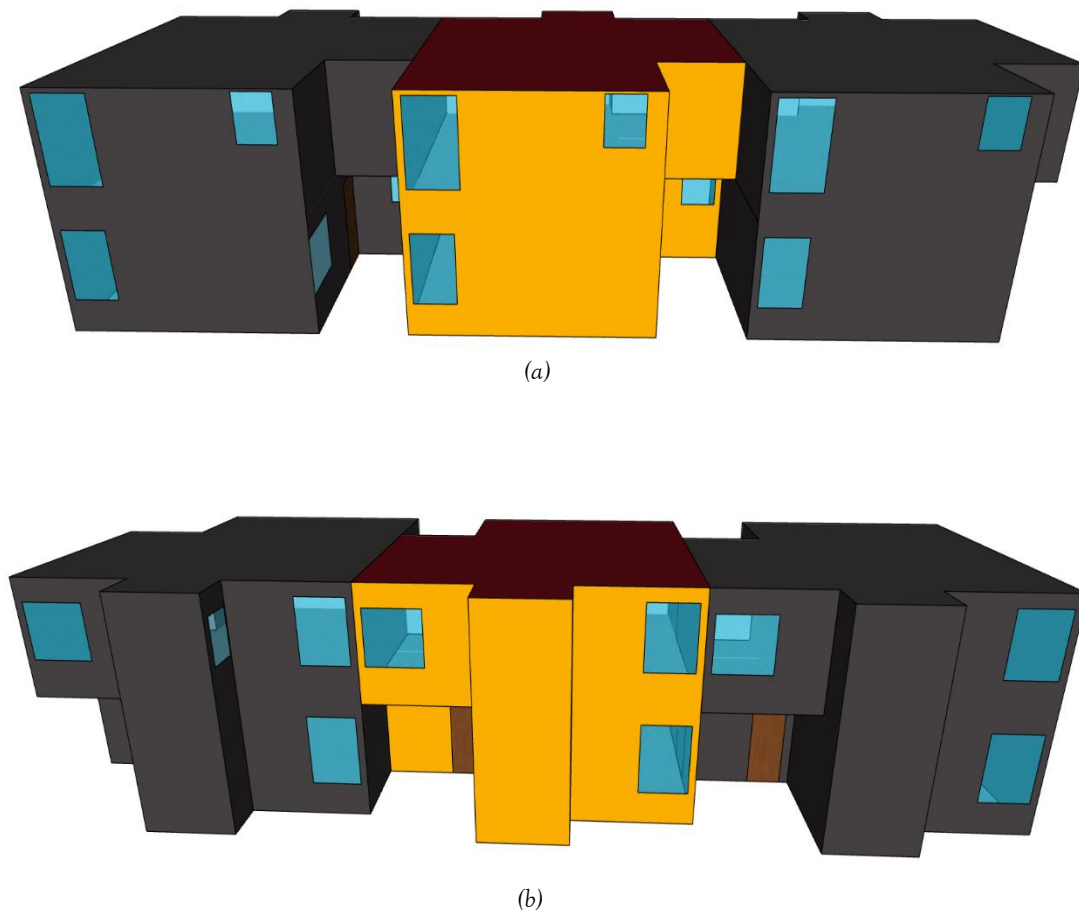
Conjunto de viviendas (a) fachada norte, (b) fachada sur
